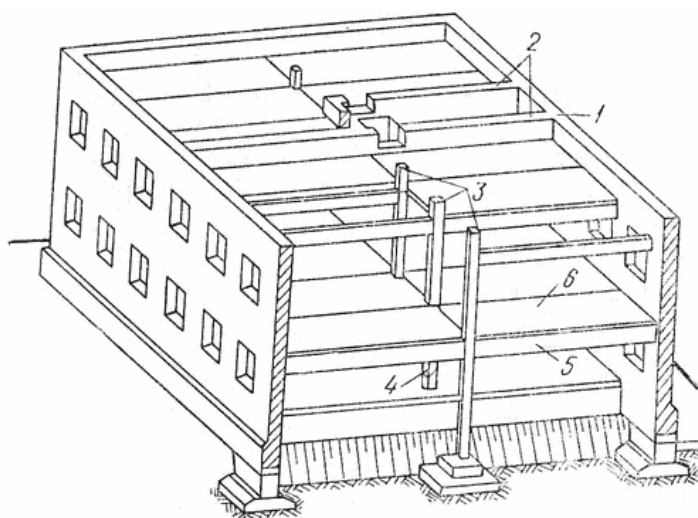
Будівля з зовнішніми несучими стінами і внутрішнім каркасом: 1 – несучі стіни; 2 – стіни сходової клітки; 3 – колони; 4 – стик колон; 5 – ригелі (прогони); 6 – плита перекриття
